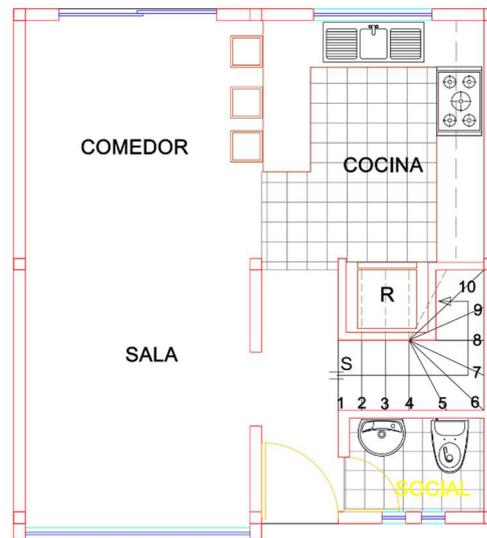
Distribución Espacios Planta Baja Casas Tipo B.
